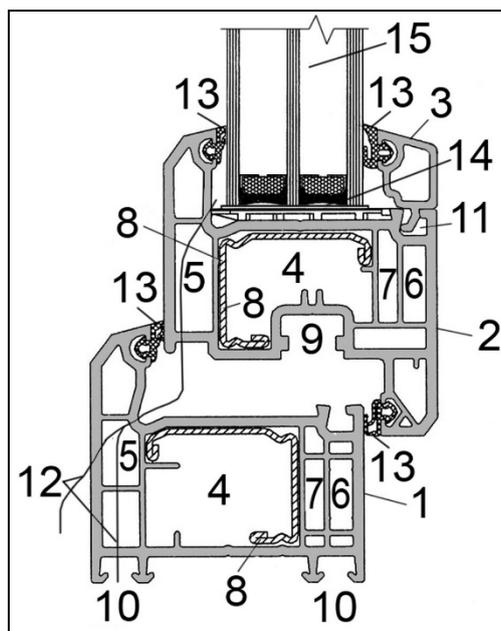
Поперечное сечение оконного блока с 4-камерными ПВХ профилями; 1 – профиль коробки, 2 – профиль створки, 3 – штапик, 4 – основная камера, 5 – дренажная камера, 6 – камера для крепления фурнитуры, 7 – дополнительная камера для повышения теплозащитных свойств профиля, 8 – армирующий профиль, 9 – паз для крепления фурнитуры, 10 – пазы для крепления дополнительных профилей, 11 – паз для крепления штапика, 12 – водоотвод из профилей, 13 – уплотнители, 14 – подкладка под стеклопакет, 15 – 2-камерный стеклопакет
